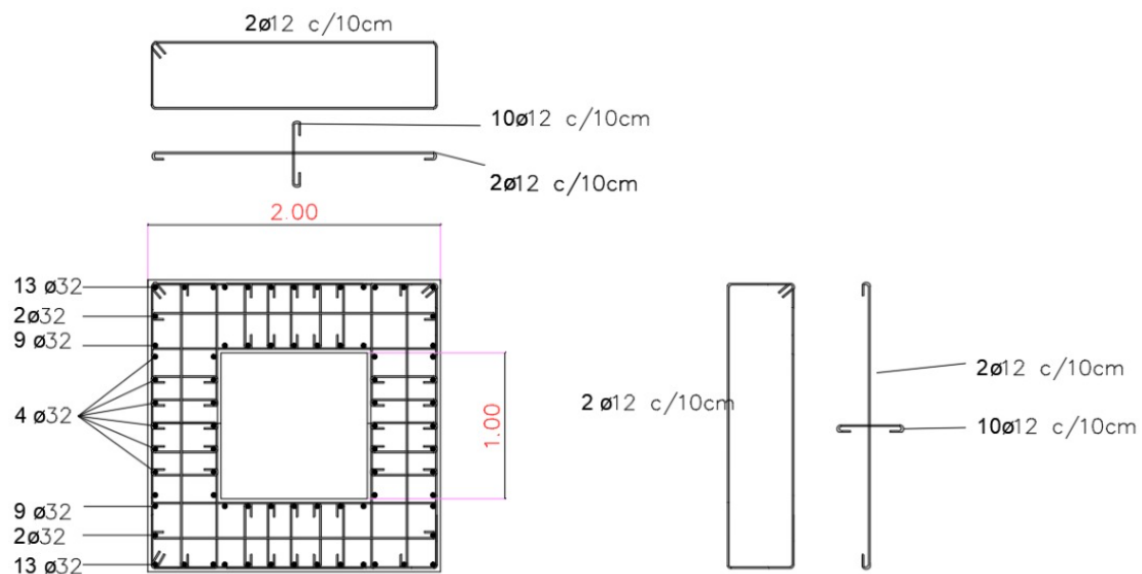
Armadura transversal en las zonas extremas de la parte inferior de las pilas (Desde H = 0 a H = 2,6 m y desde H = 13,4 m a H = 16 m).
